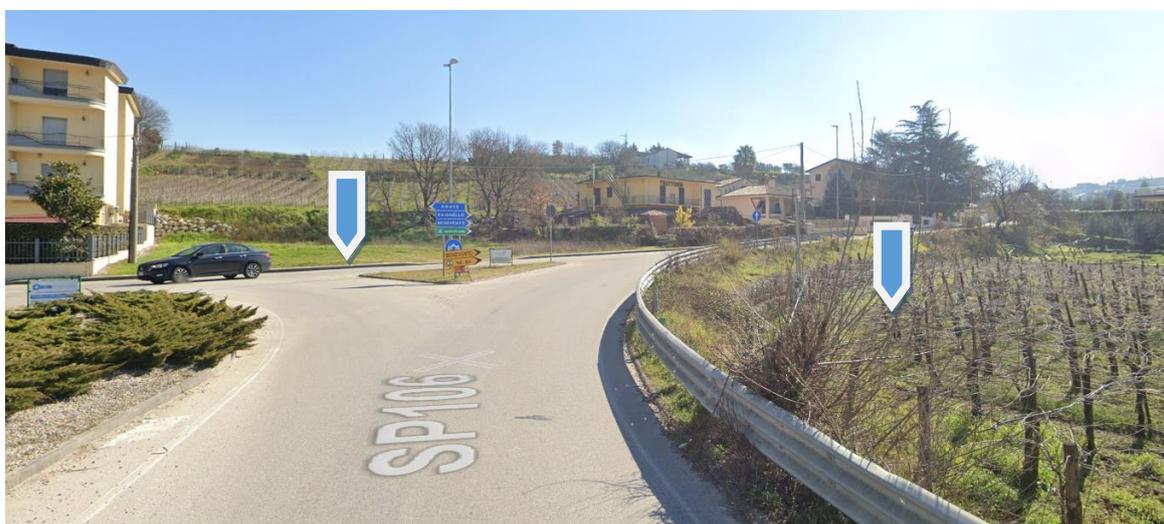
Vista area di cantiere superiore e inferiore dalla SP106
